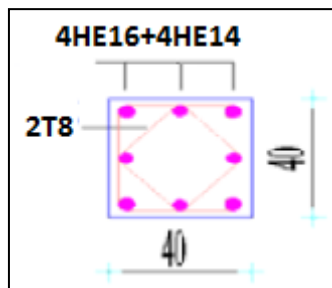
Coupe transversale de ferraillage des poteaux(RDC)
